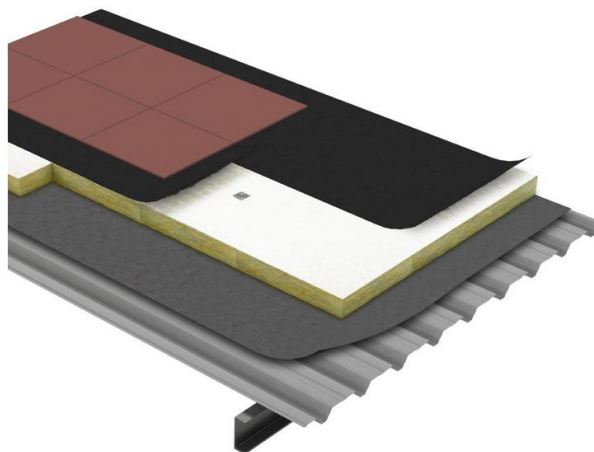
Detalhe construtivo da cobertura WalkRock, [89].
